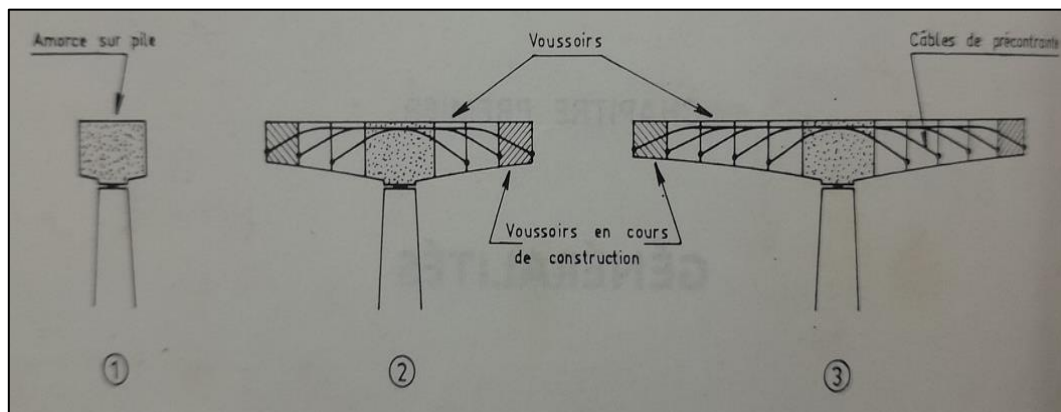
Différents procédés de construction par bétonnage en place des voussoirs
